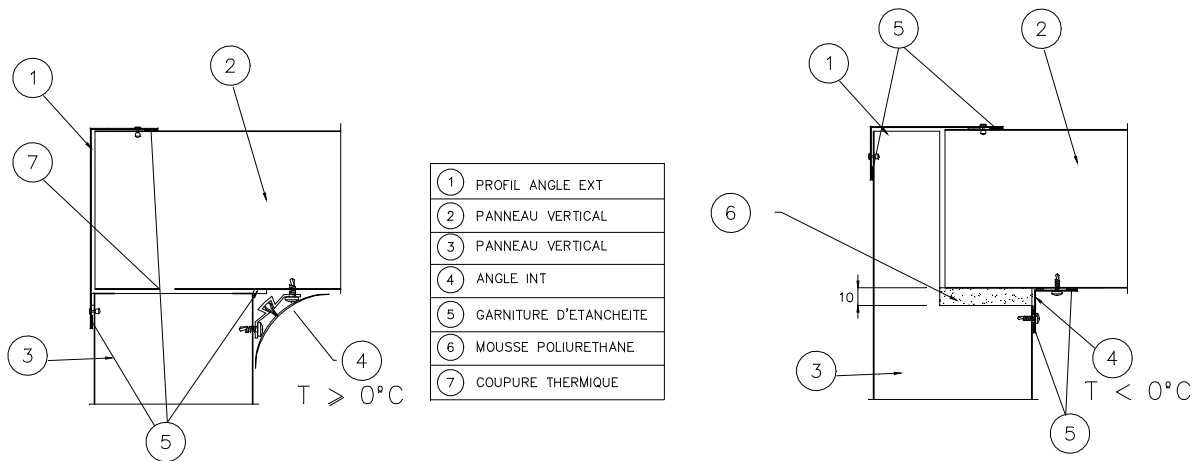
Jonction paroi-paroi (Pour montage à mi-bois panneau de paroi d'épaisseur minimale 100mm)
